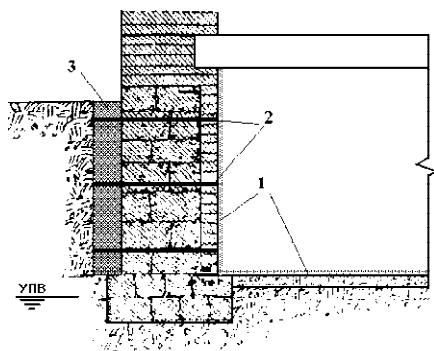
Гидроизоляция подвала при низком уровне подземных вод:
